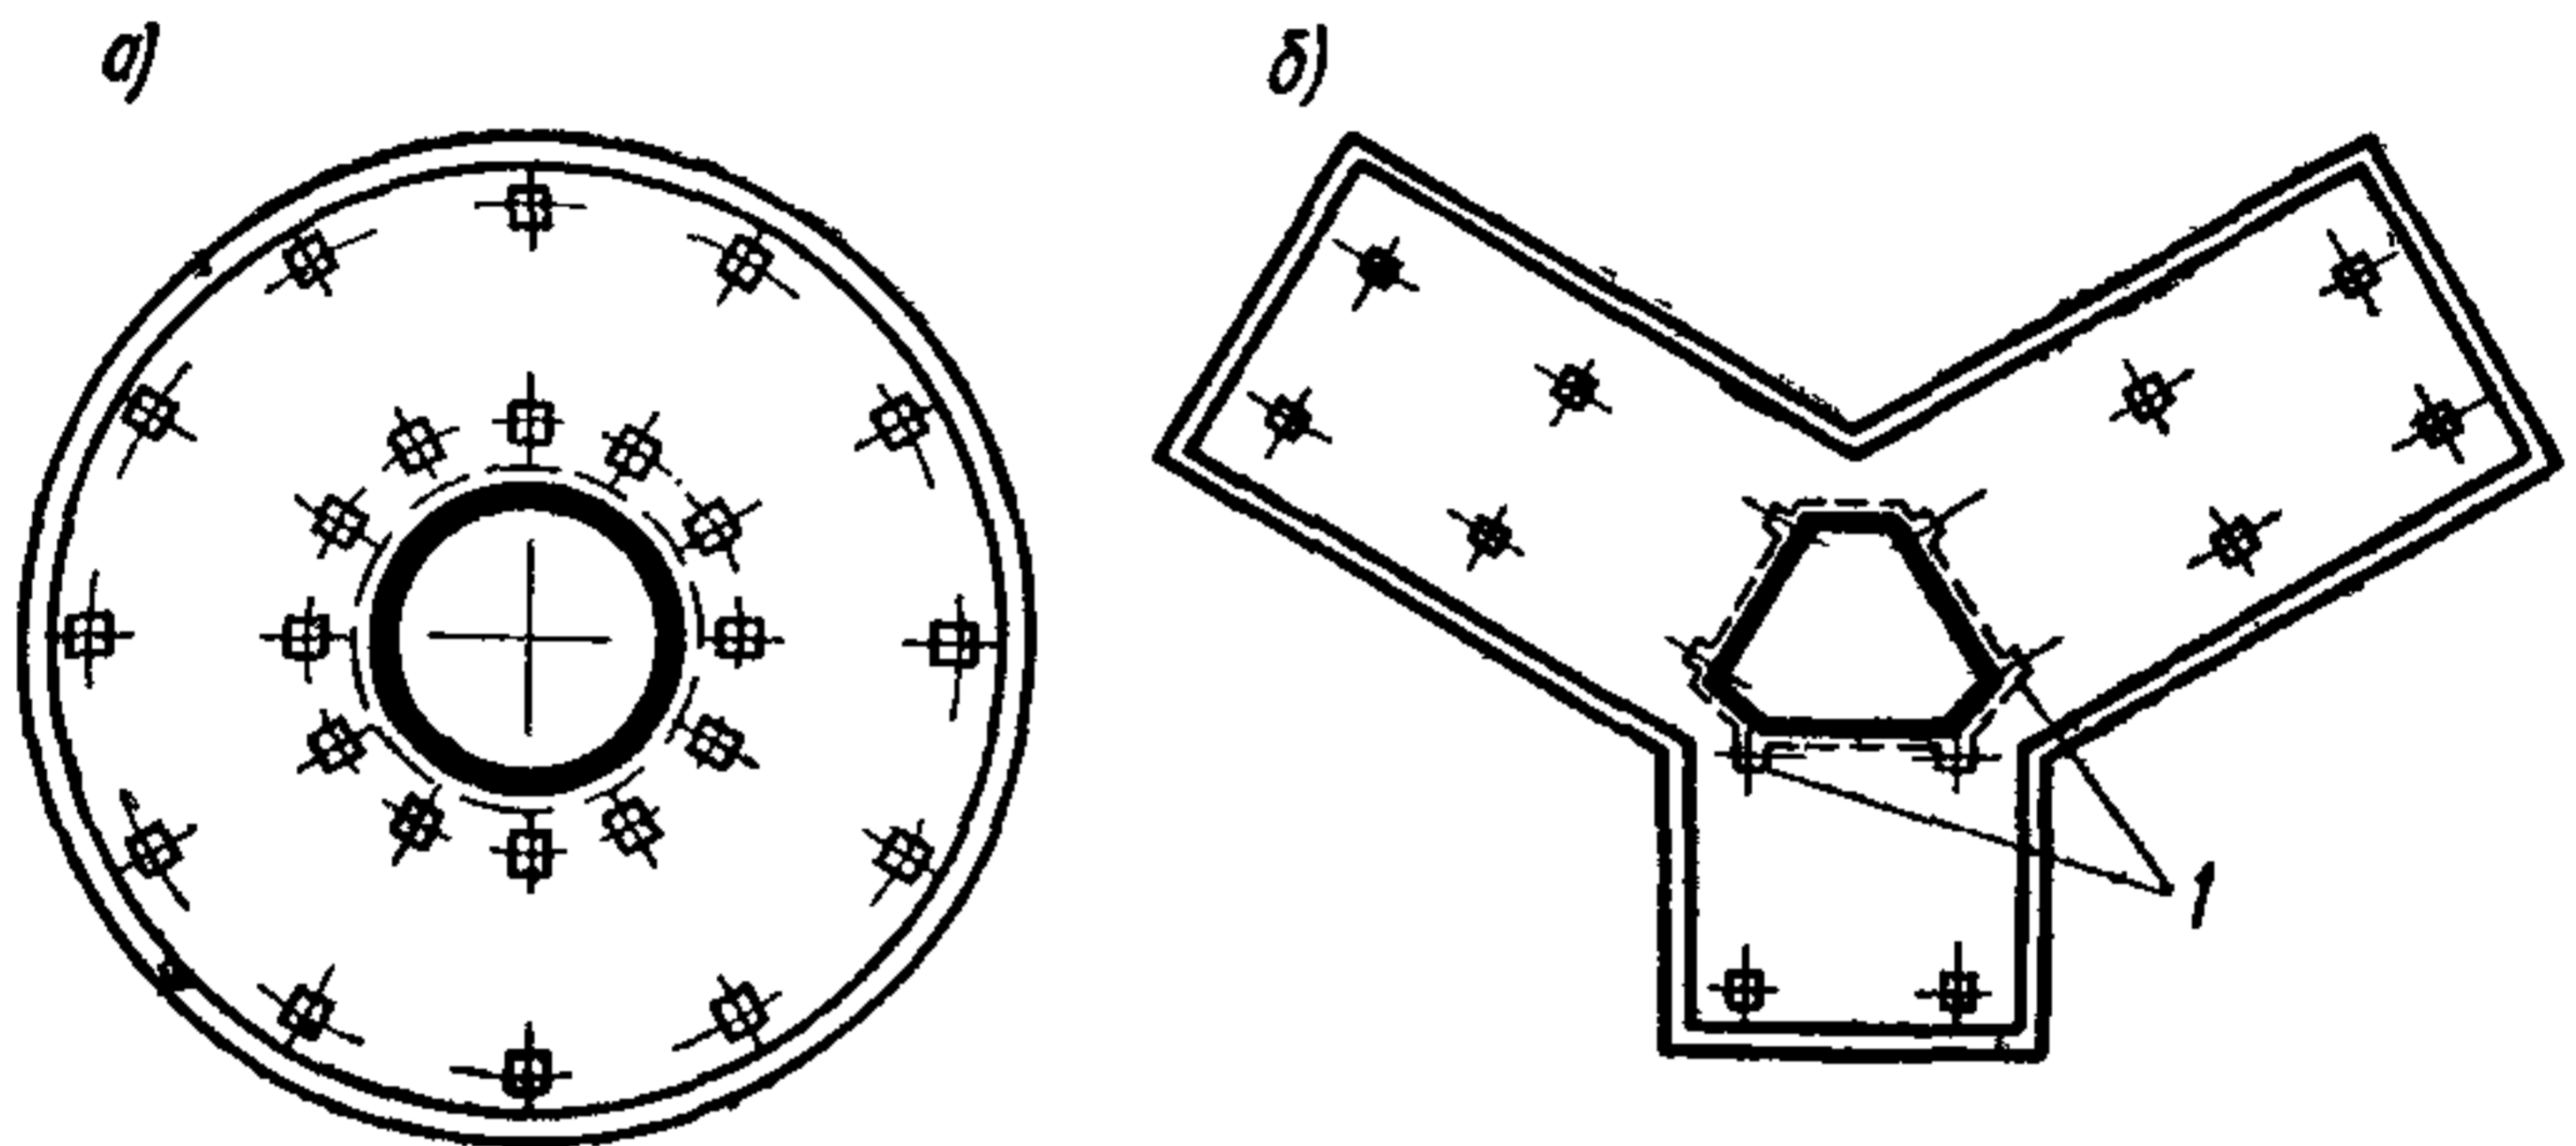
Примеры решения центральных зданий с различной сеткой колонн и примыканием перекрытий к ядру жесткости (лестнично-лифтовой шахте)
